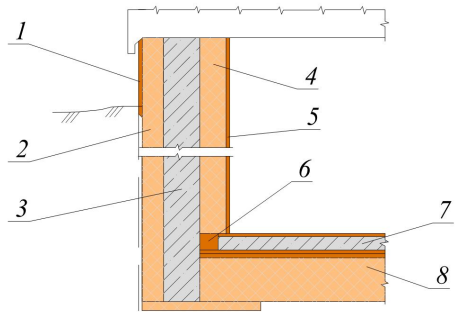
Утепление узла сопряжения пола по грунту с наружным и внутренним утеплением (внутренний слой тепловой изоляции из пенополистирола): 1 – штукатурка; 2, 4 – пенополистирол; 3 – ж/б стена; 5 – гипсокартон; 6 – термический вкладыш (строительная пена); 7 – армированная цементно-песчаная стяжка; 8 – два слоя жестких плит пенополистирола
